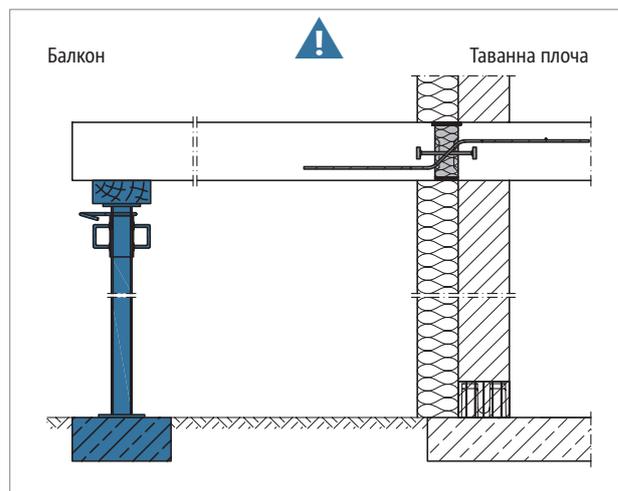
Schöck Isokorb® T mun QL-VV: Постоянното подпиране е необходимо
